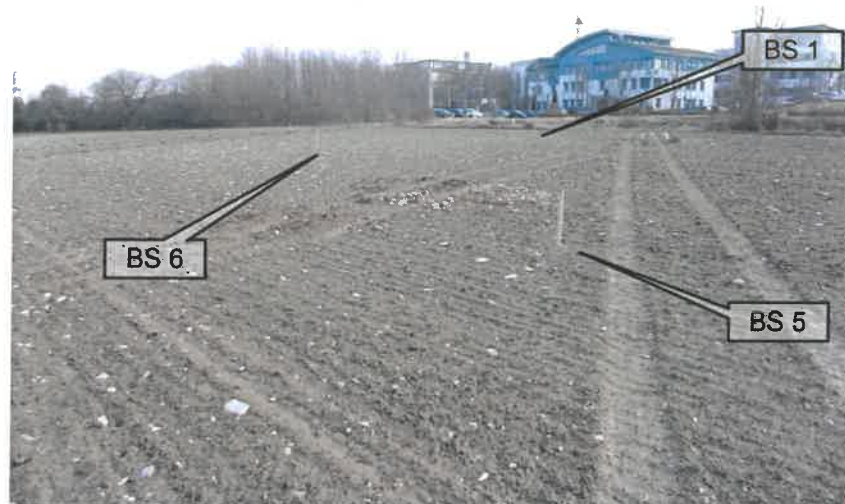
Blickrichtung ~ O; Bereich der BS 1, BS 5, BS 6 (Markierungen)
